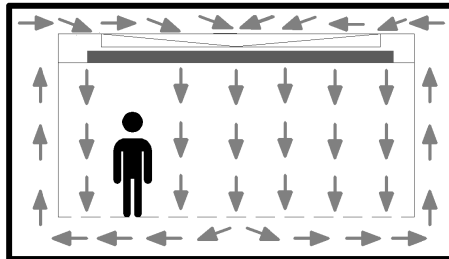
Kolbenlüftung I (Werkbild: FfH – Fachplanung für Haustechnik)
